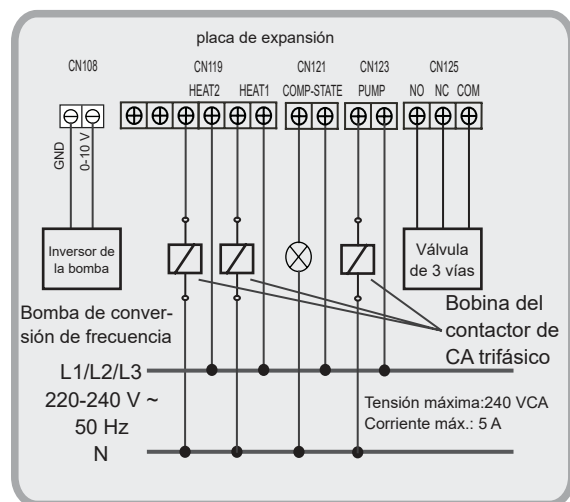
Cableado del calentador auxiliar de la tubería y de la luz CA del estado del compresor (50/60/70kW)
